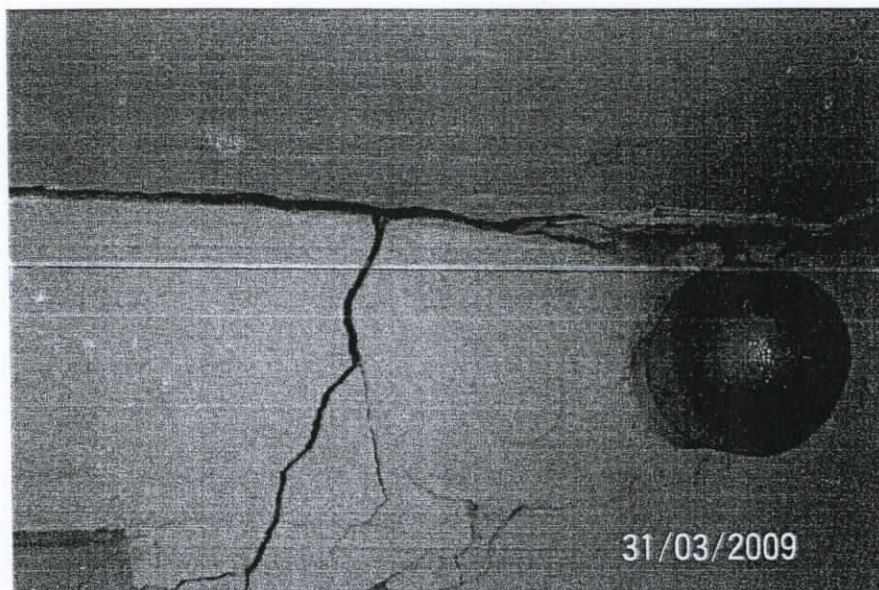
Dyslokacje konstrukcji murowej w poziomie terenu.
